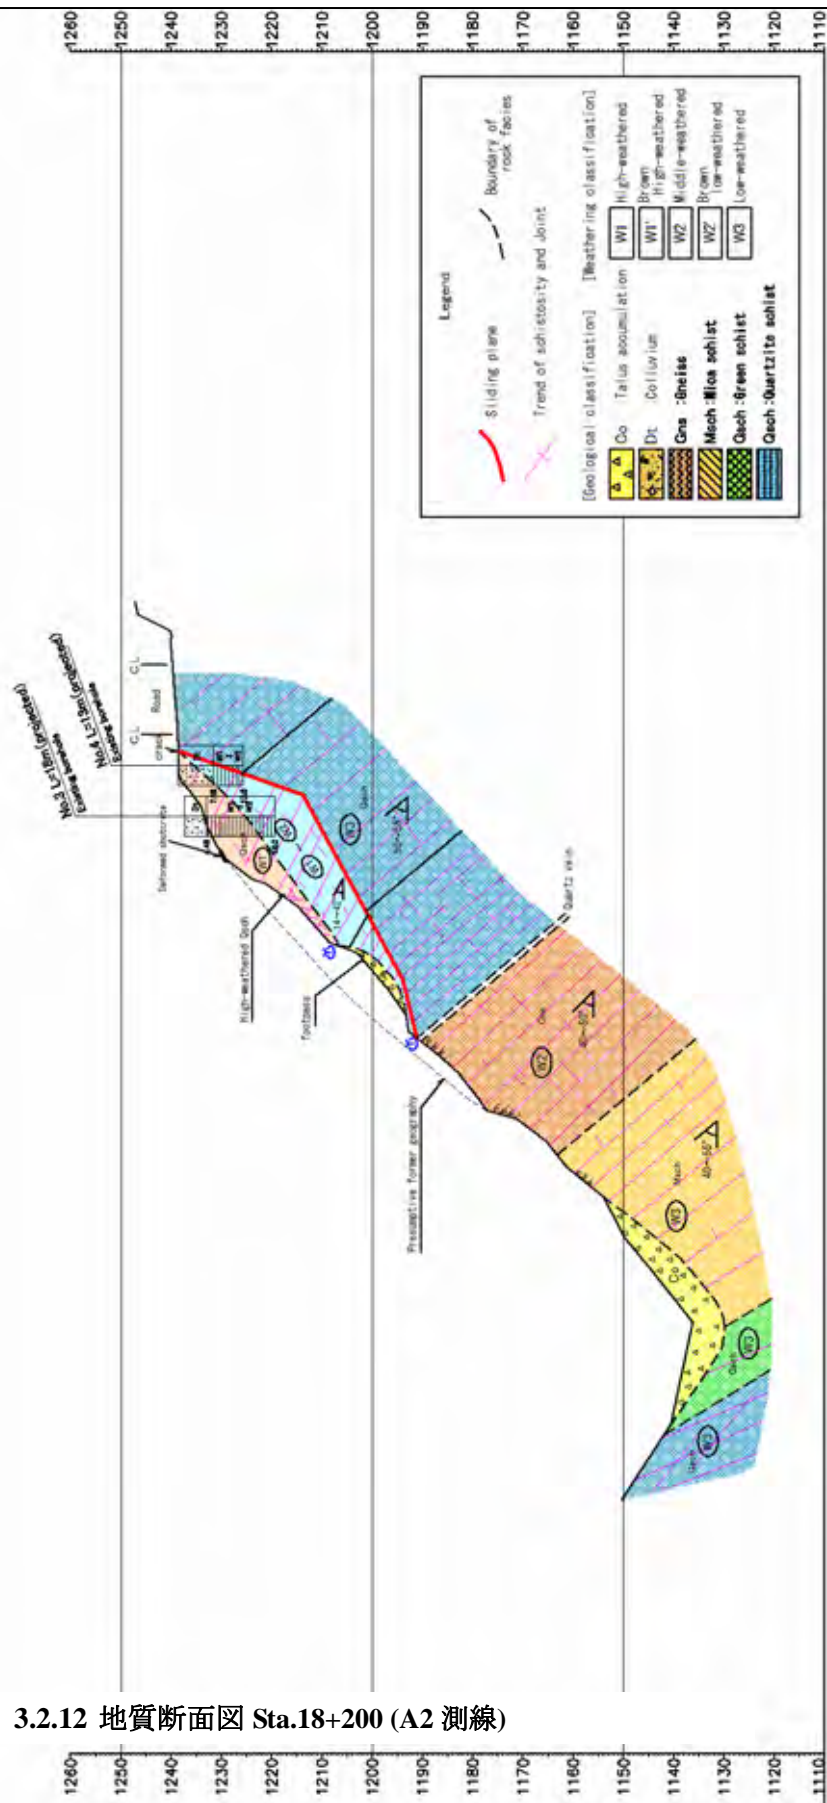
地質断面図 Sta.18+200 (A2 測線)
